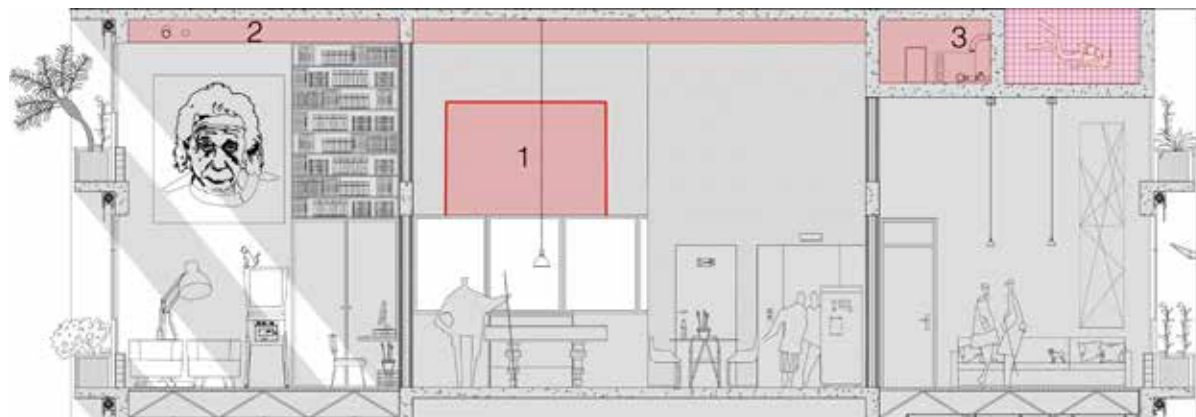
Corte transversal do sexto pavimento, com destaque para as infraestruturas que fazem uso de pé direito duplo: 1- Projecção da caixa de captação de água pluvial 2- Entreforro para a passagem de instalações hidráulicas 3- Piscina e suas instalações de filtragem.
